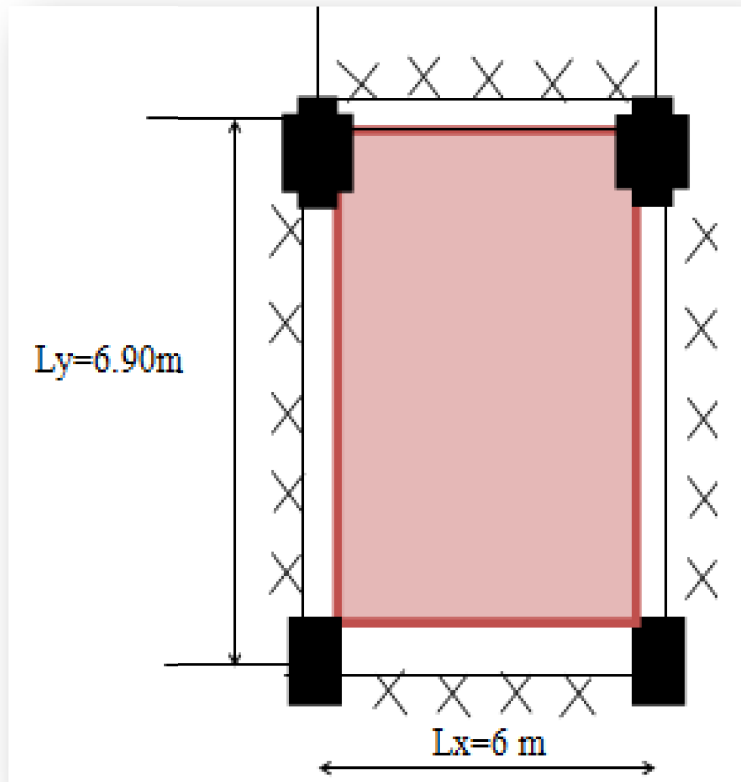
Dimensions de la dalle pour plancher à étage courant.
